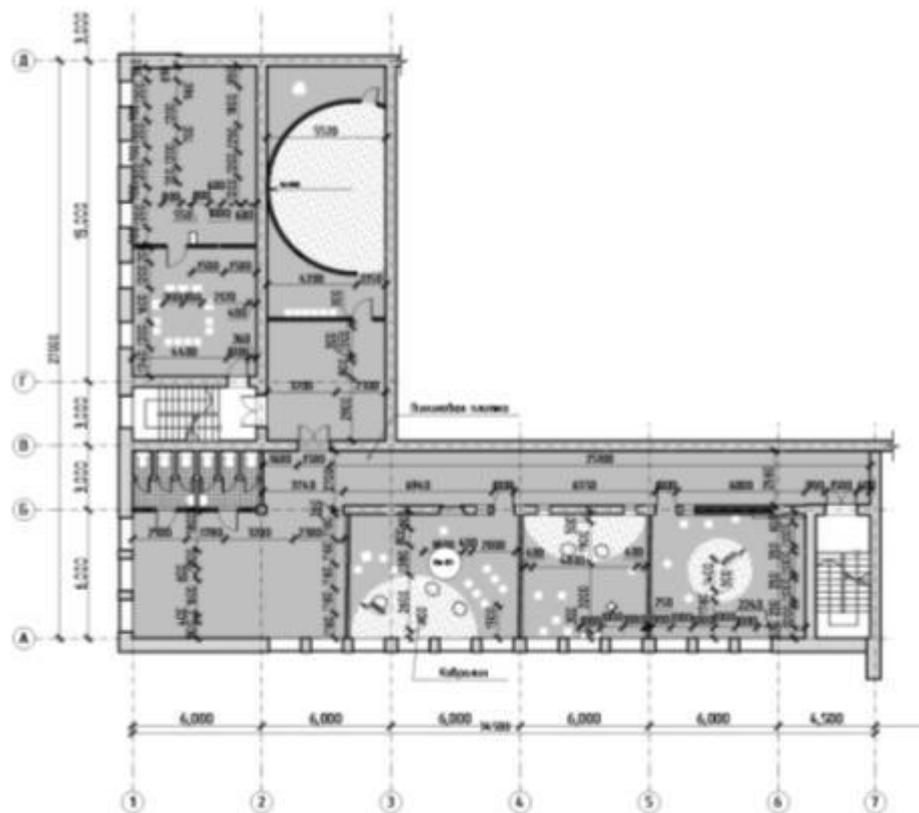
План пола с расстановкой оборудования. 3 этаж
